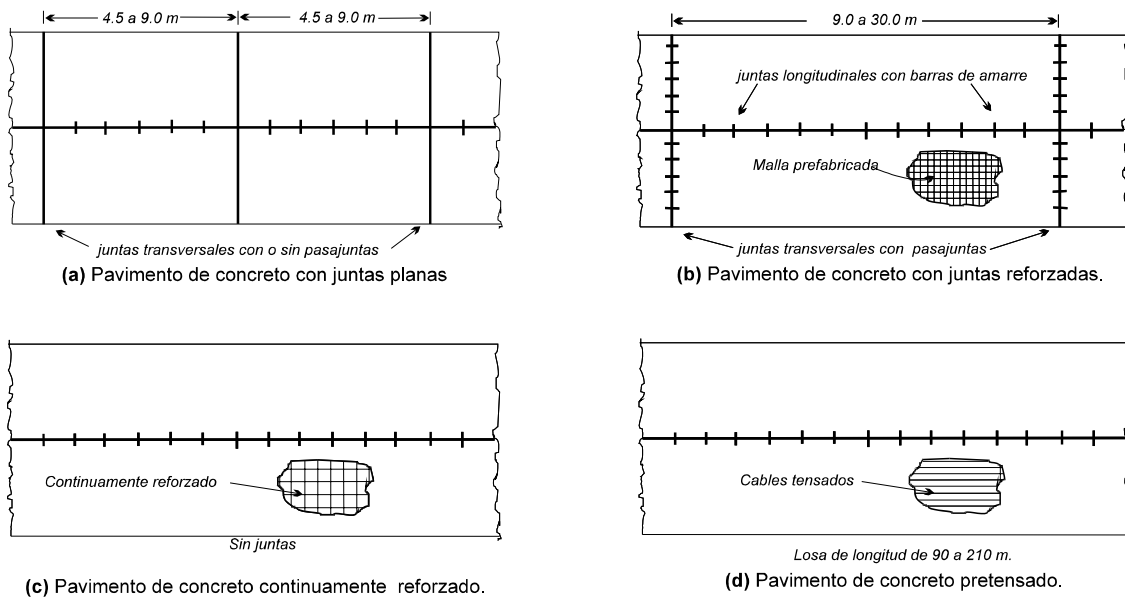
Tipos de pavimentos de concreto hidráulico
